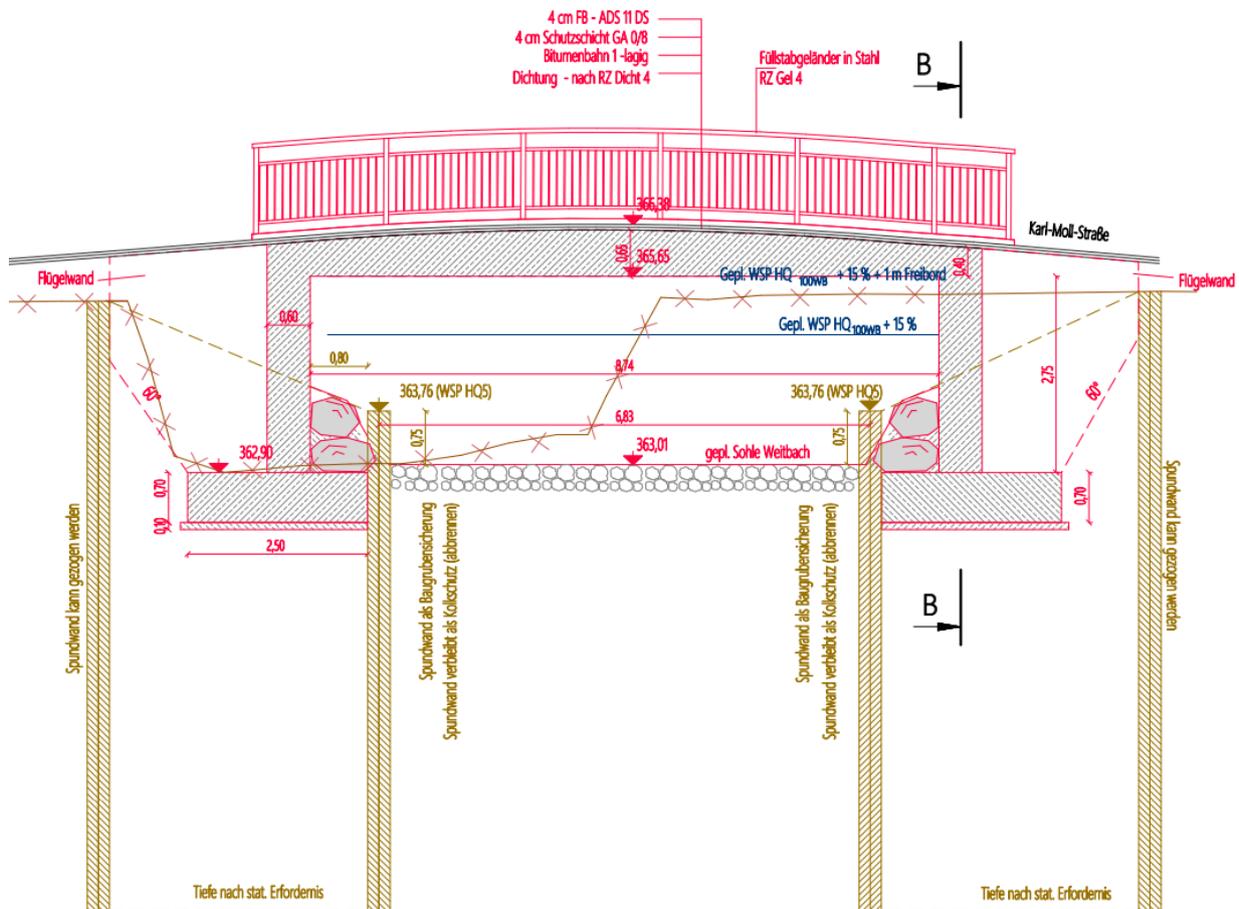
Querschnitt Detailplanung Brücke Karl-Moll-Straße (Anlage 7.4)
